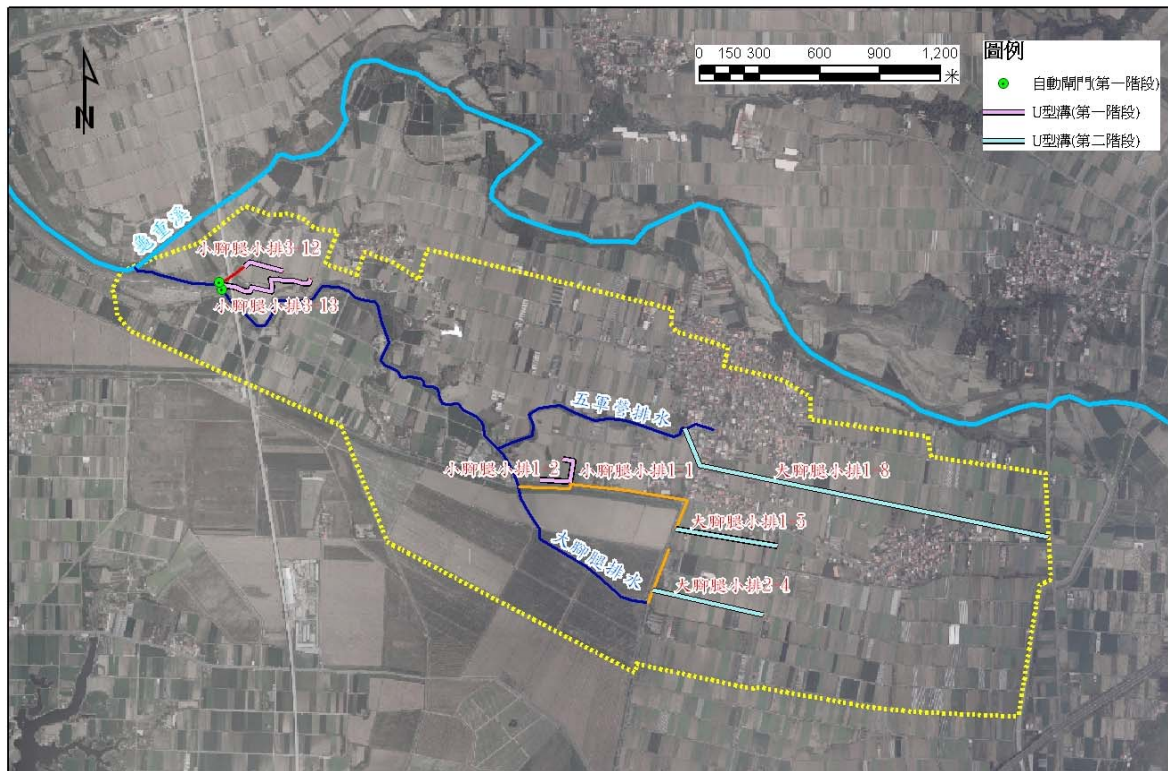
大腳腿排水系統農田排水路工程平面布置圖
